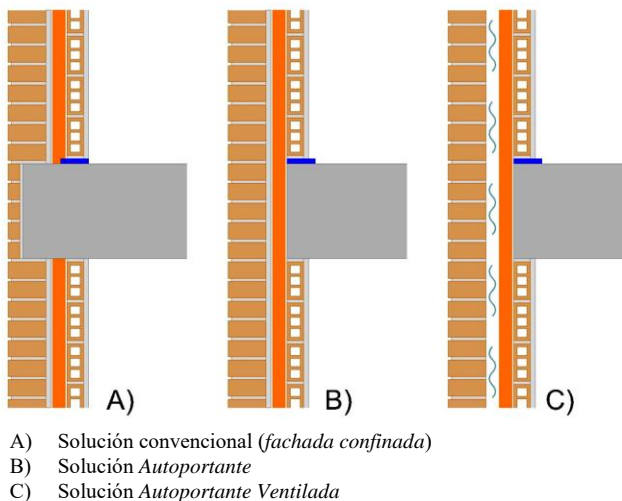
Tipos constructivos de fachada de ladrillo cara vista.
